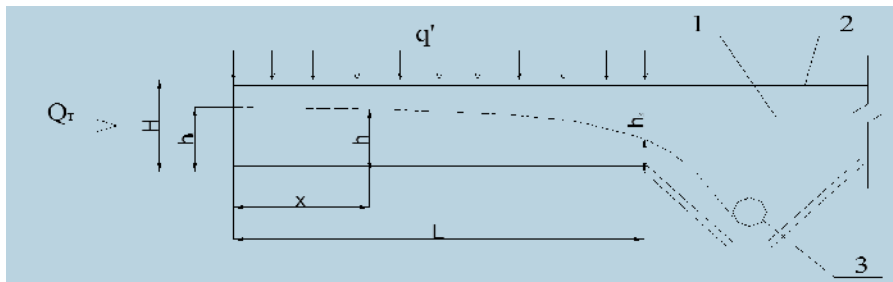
Расчетная схема бесполостной дрены трапецидального поперечного сечения
